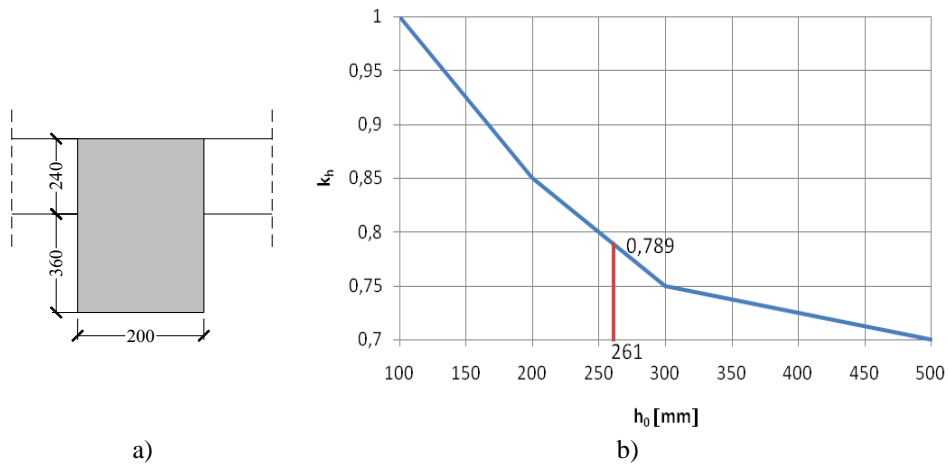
a) Sezione rettangolare di 200 x 600 mm,
